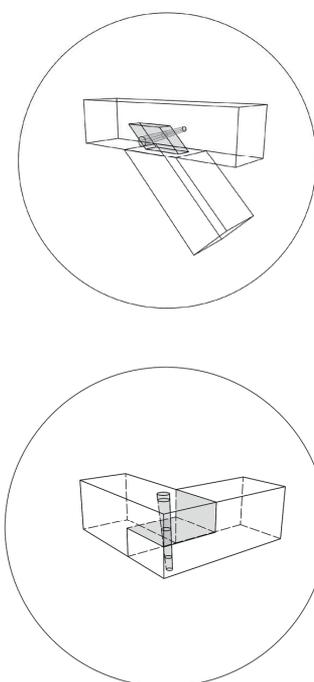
Oben Verzapfung, Unten Verblattung als traditionelle Holzverbindung im Fachwerkbau (Quelle: Sarah Belke)
